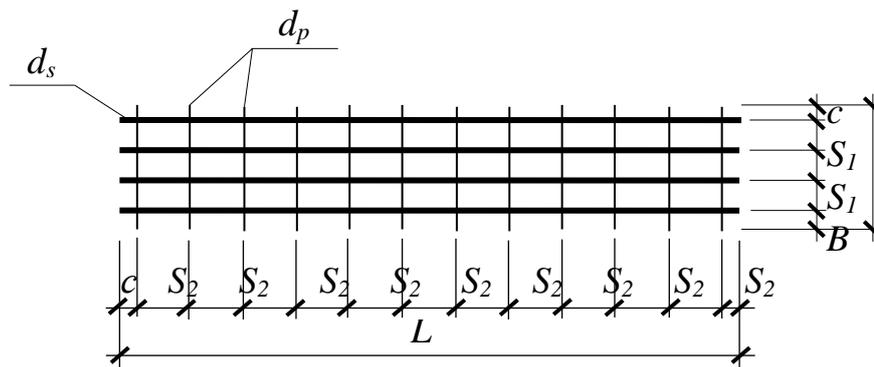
Сітка з поздовжньою робочою арматурою $d_s > d_p$, $S_1 < S_2$,
